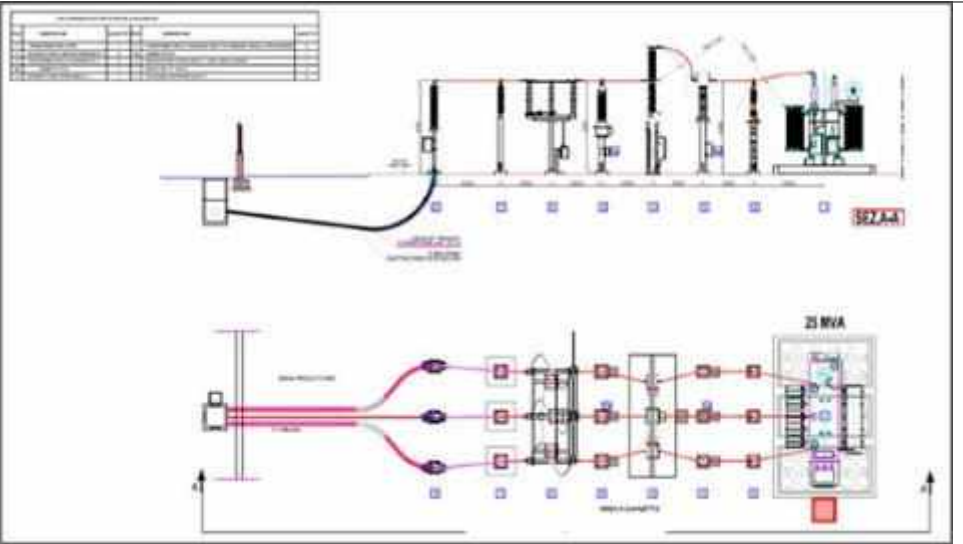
9 Sezione longitudinale dello Stallo TR + Sbarre parallelo comuni 4
